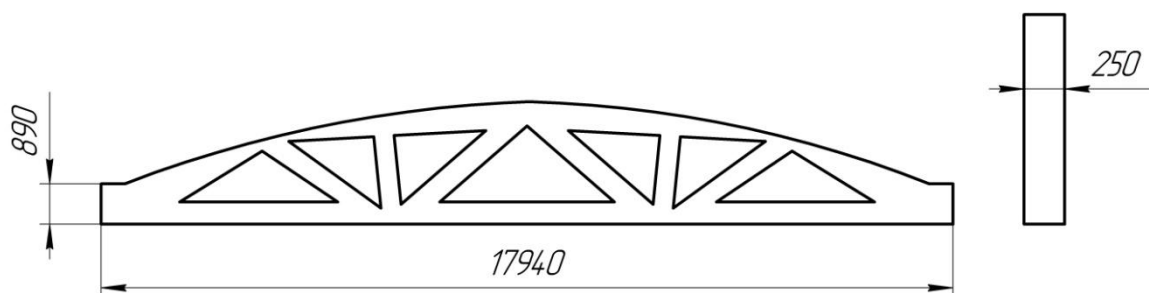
Габаритные размеры железобетонных ферм
